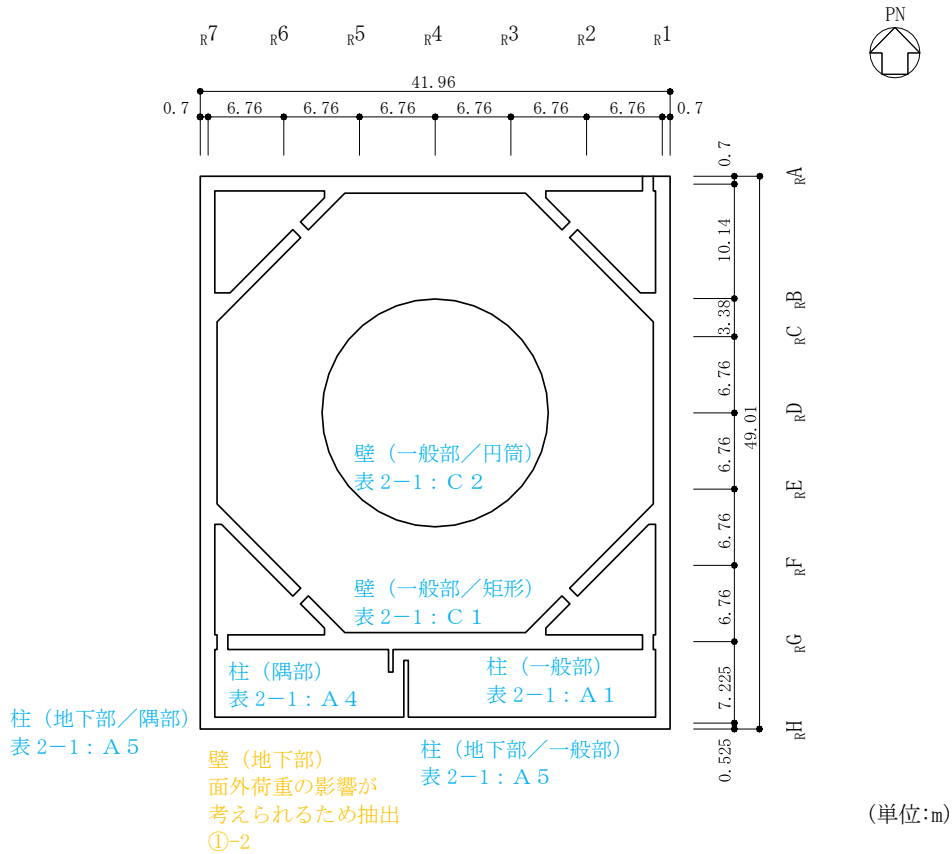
1号機原子炉建物の概略平面図 (EL 3.1m)
